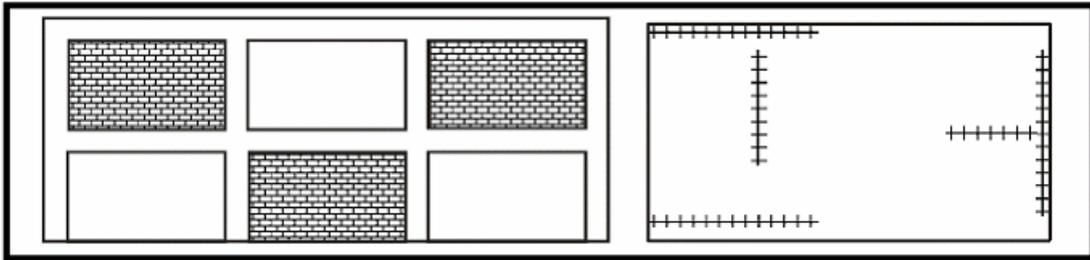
Disposición incorrecta de elementos no estructurales
